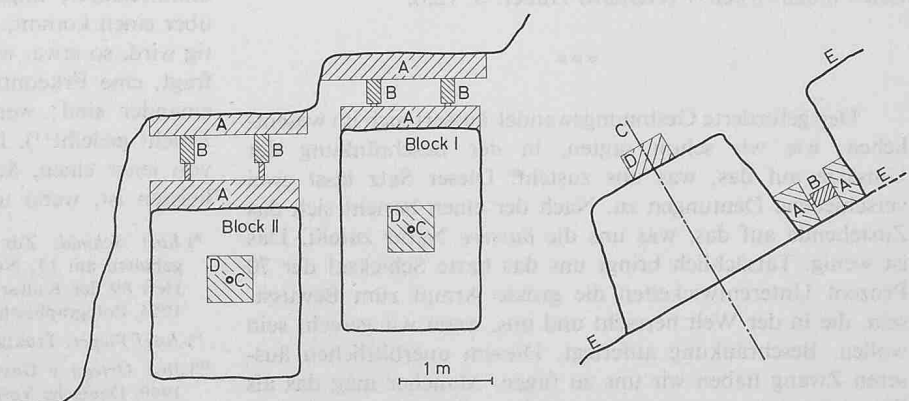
Versuchsanordnung in situ, Massstab rund 1:80. A Betonwiderlager, B Hydraulische Presse, C Felsanker, D Betonkörper, E Schichtfläche
